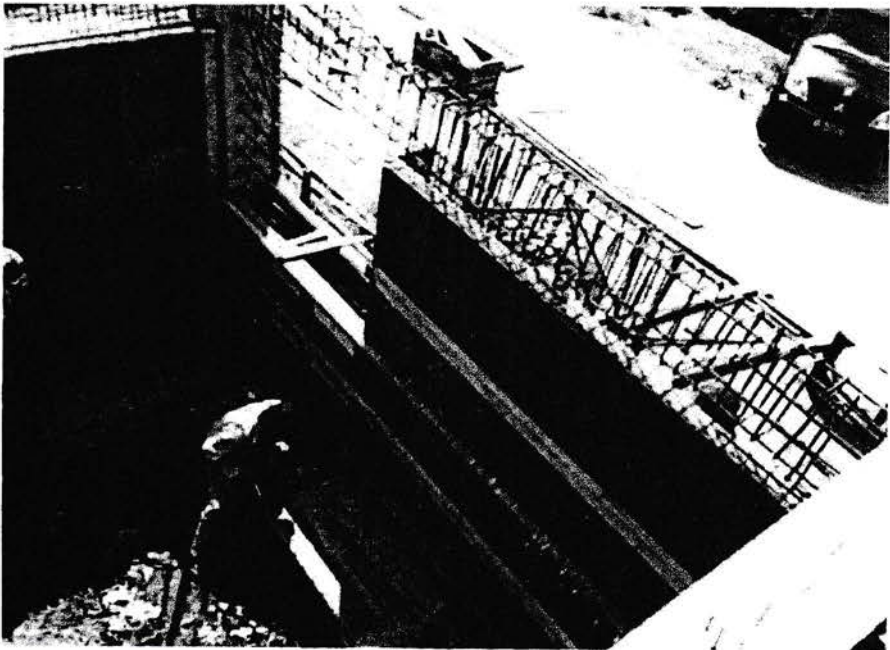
Kolom yang telah dipasang tulangan sambungan untuk sheerwall.
